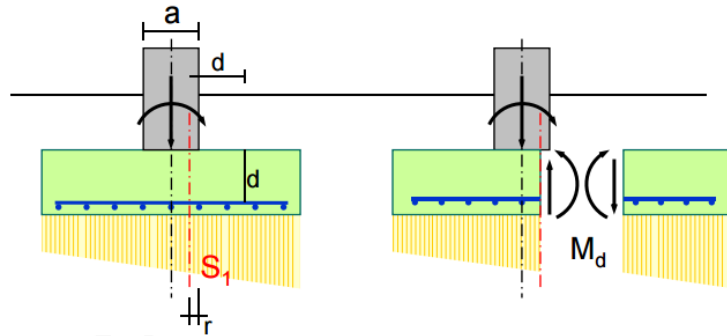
Corte en la sección S1. Fuente: Apuntes de la asignatura de Estructuras de Cimentación y Contención
